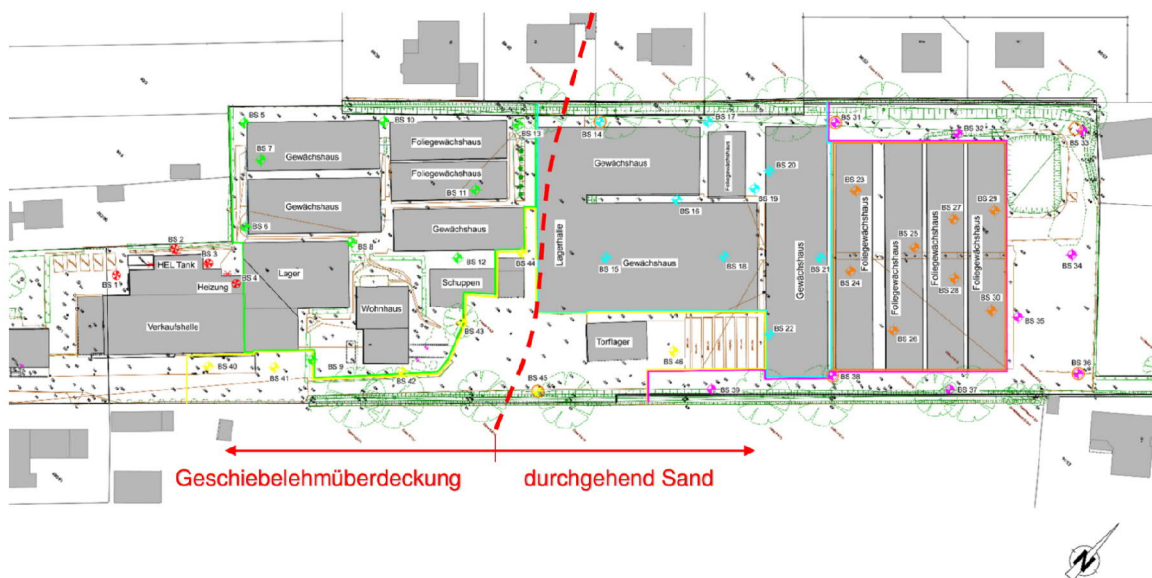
Lageplan zur Aufteilung bezüglich der Böden (nicht genordert)
